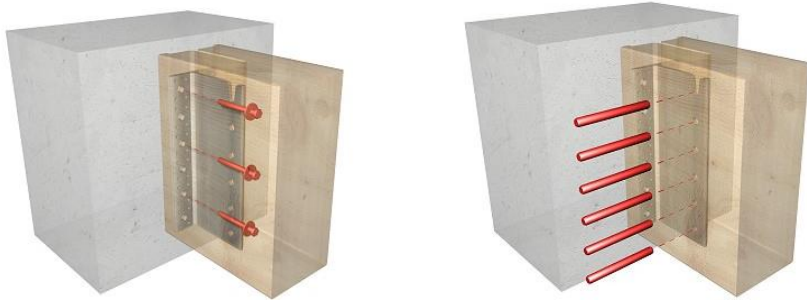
Detalle unión viga madera – Viga hormigón. 2024. Fuente: Cype.com
